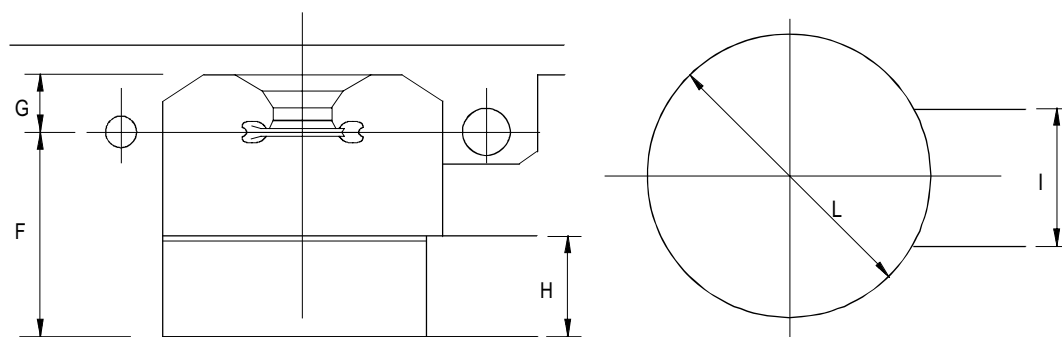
Planta e corte da câmara blindada – Turbina Pelton.
